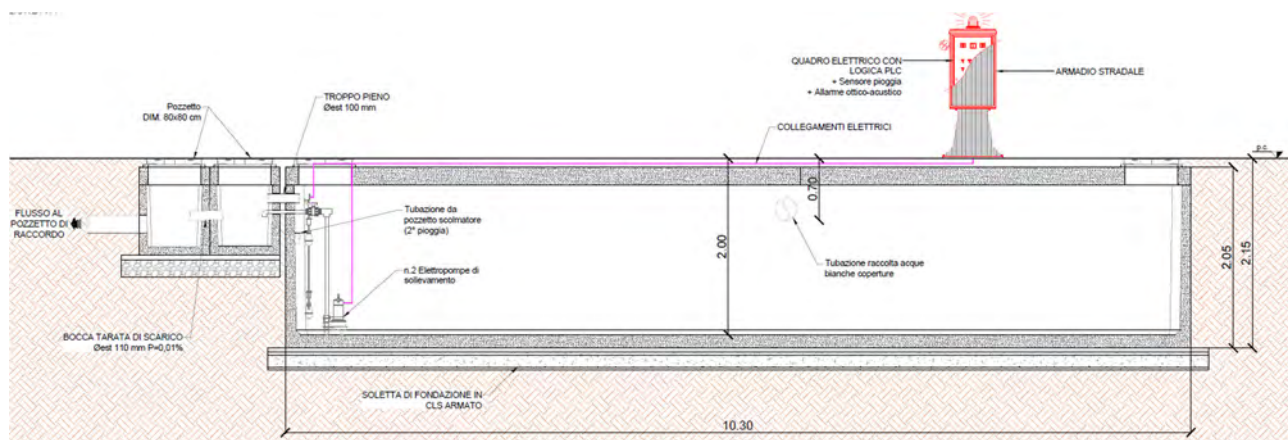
Sezione vasca di laminazione (stralcio Tav. 8)
